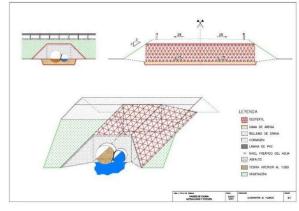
Pasos de fauna en cruces viales con la Quebrada San Juan Fuente: DTS del POZ Norte
